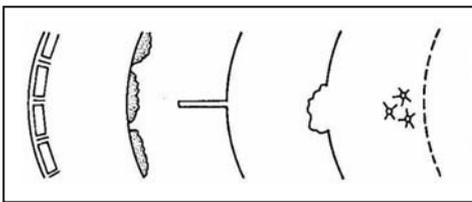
Divers artifices employés pour maîtriser l'excès de contrainte à la paroi d'un tunnel profond, des planchettes entre blocs de béton (aujourd'hui des éléments de béton compressible) aux génératrices libres entre placages de béton projeté (Tauern), à la saignée, au hors profil, ou simplement aux tirs en avant du front pour préfissurer le massif (dans chaque cas, lui "donner du mou").
